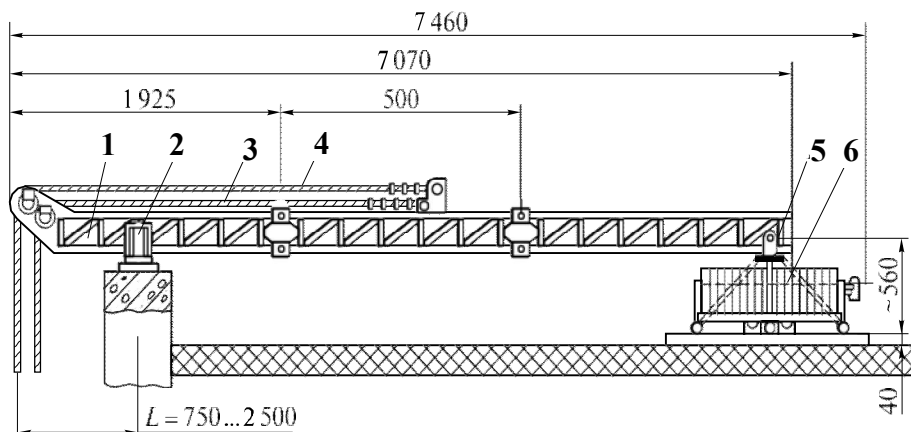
Інвентарна консоль для підвішування кошиків на фасадах будівель з плоским дахом:
